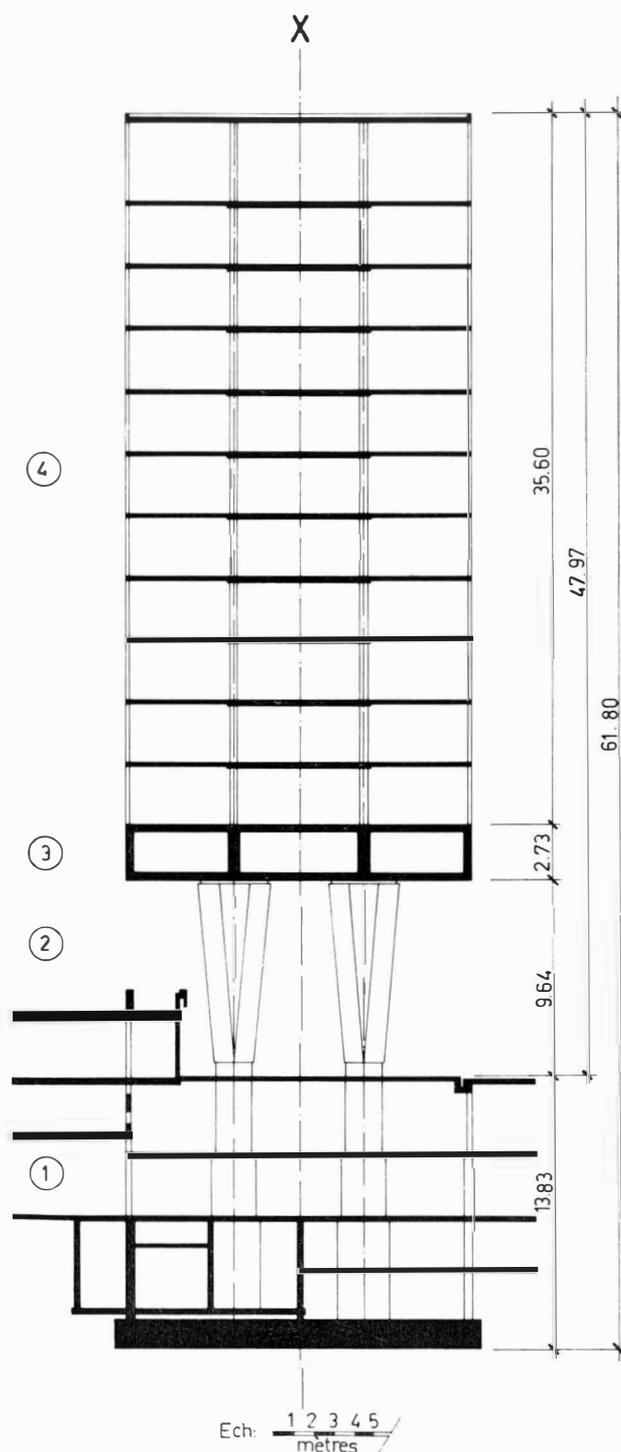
Coupe transversale du Bâtiment Principal du Secrétariat
